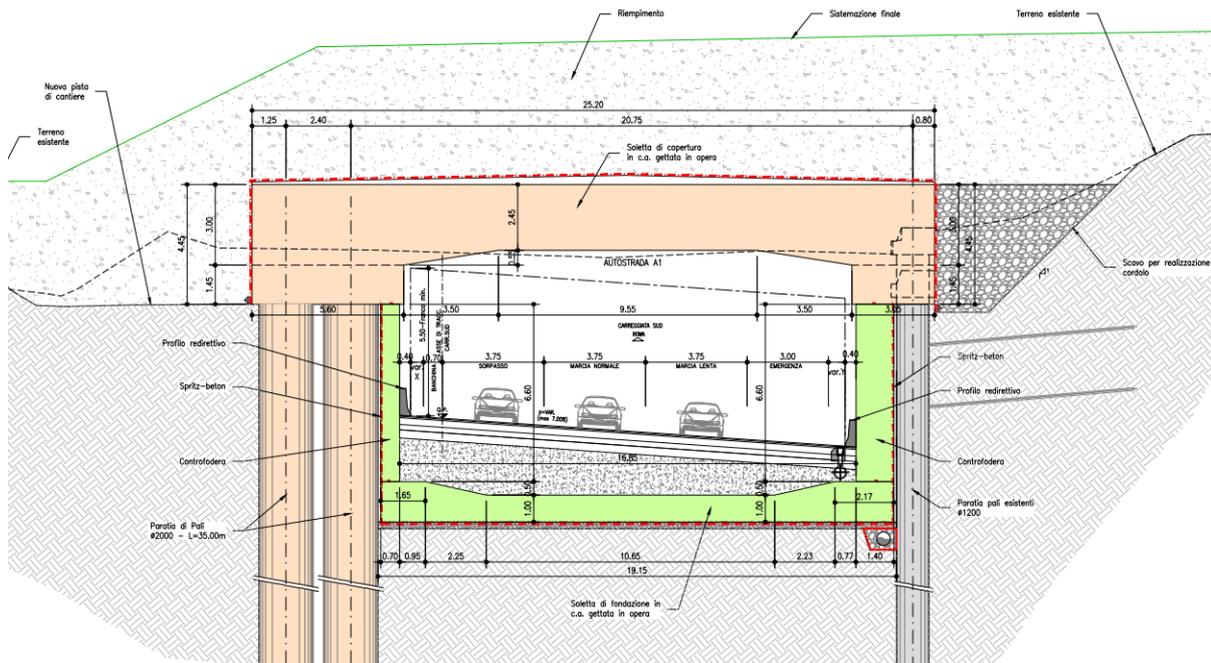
Sezione Trasversale Concio Tipo Galleria Artificiale doppia fila di pali
